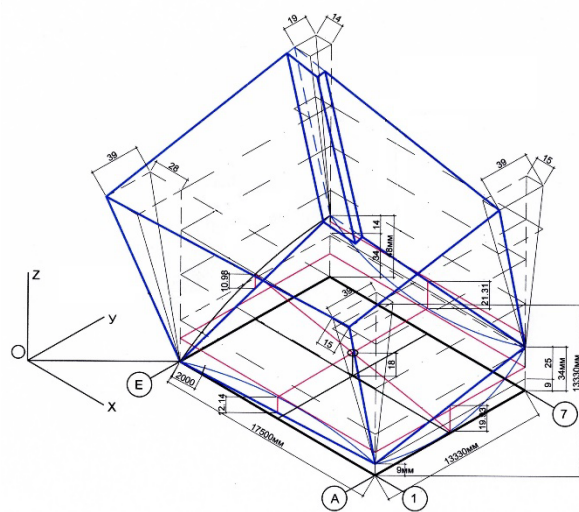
Схема просторових деформації зовнішніх фасадних стін остову будівлі
